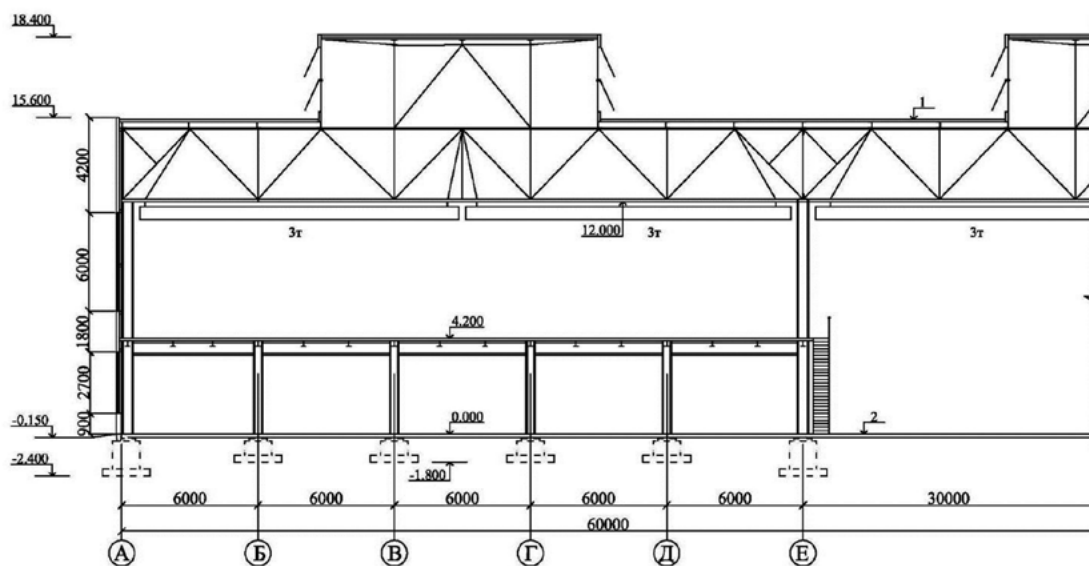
Пример фрагмента поперечного разреза производственного здания с металлическим каркасом:
